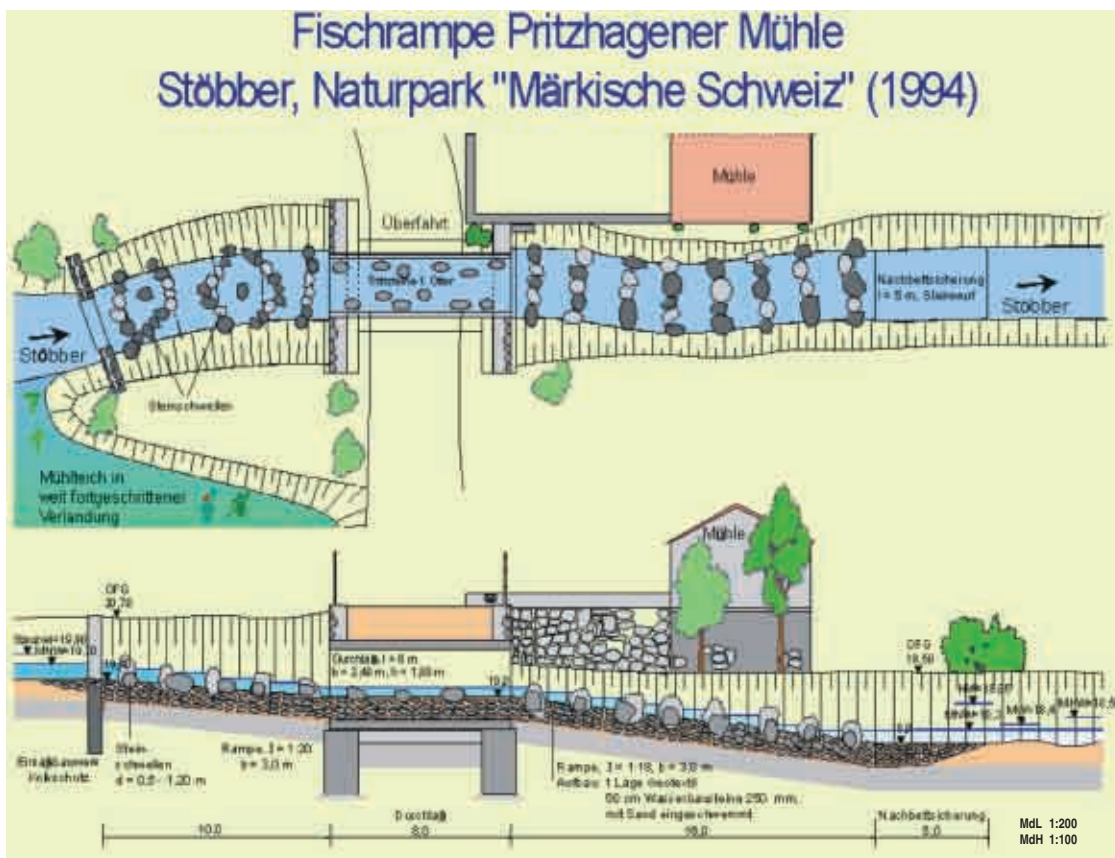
Fischrampe an der Pritzhagener Mühle
